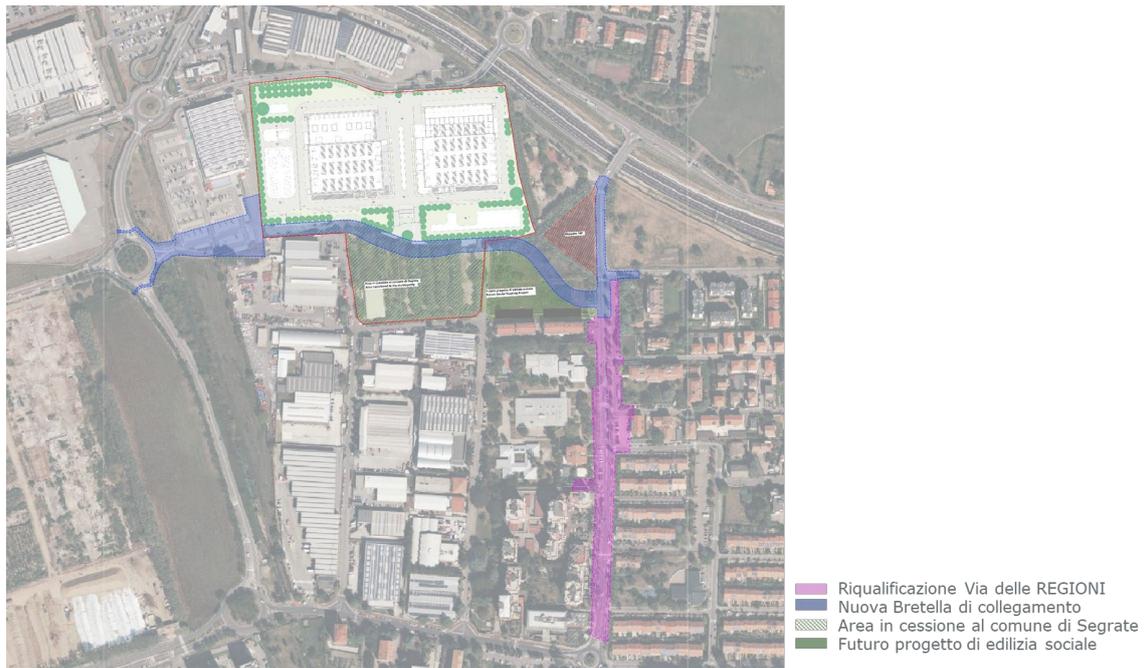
Individuazione degli interventi di progetto (elaborazione Systematica)
